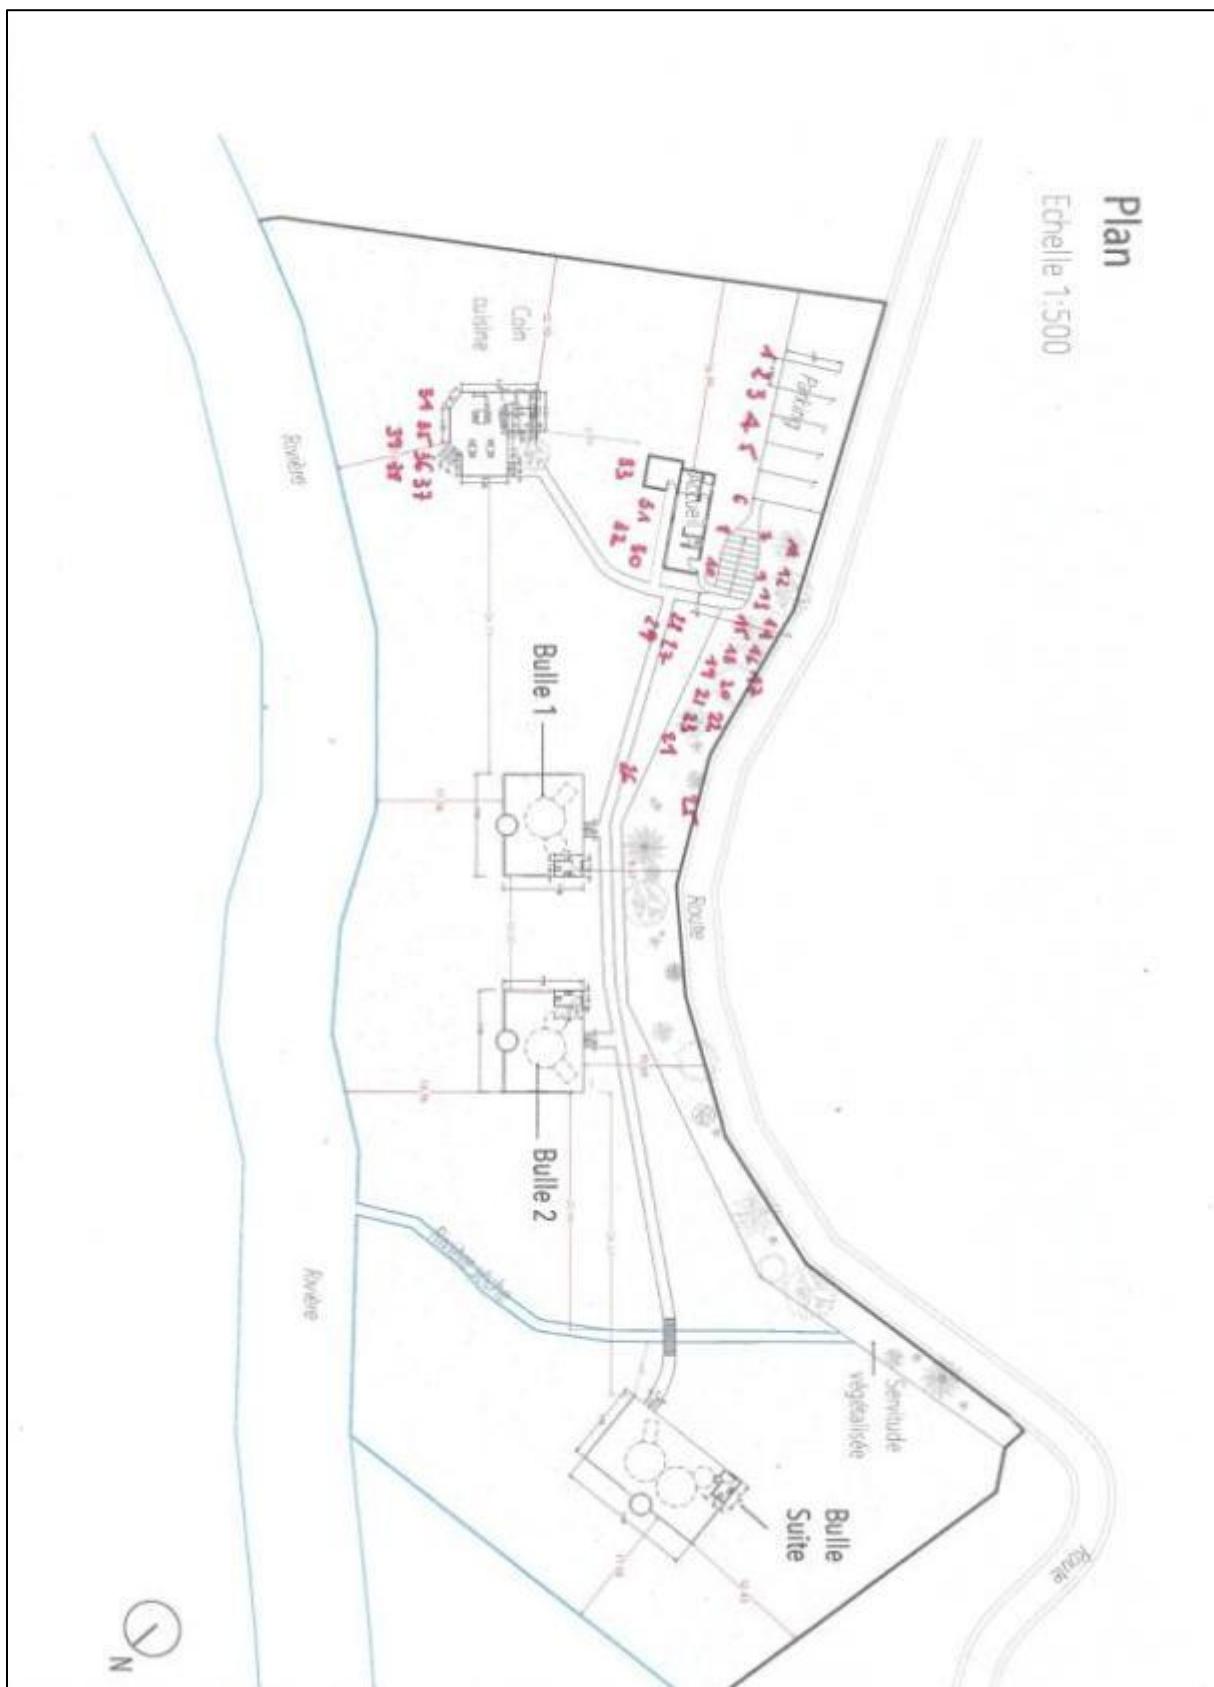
Plan des plantations déjà effectuées. Les sentiers visibles sur le plan seront recouverts de galets, comme vu avec la DENV.
